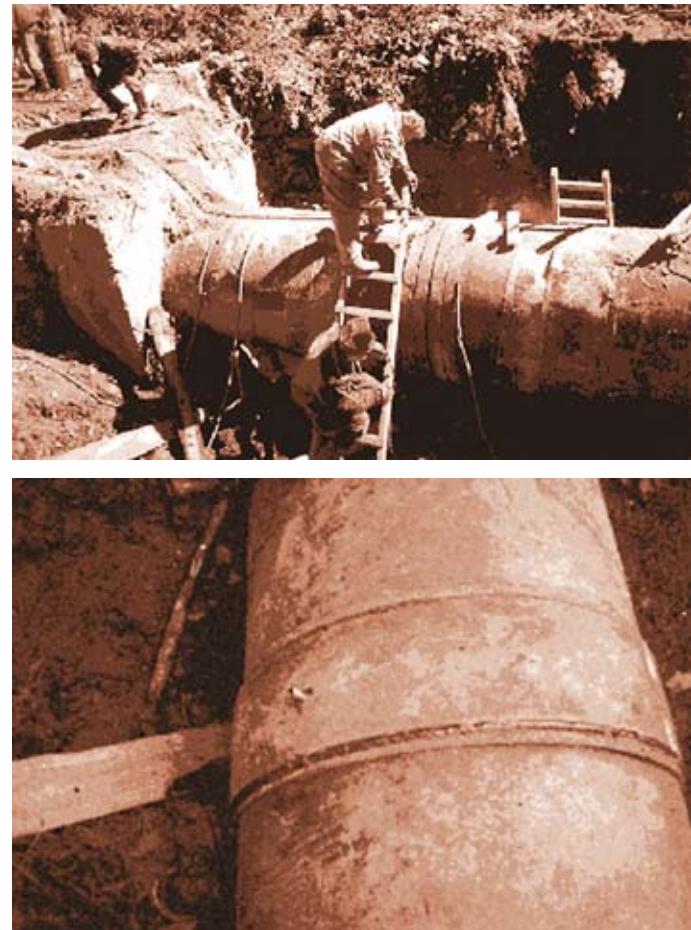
Ремонт дефектного стыка на действующем магистральном газопроводе «Союз» Ду1400: а — сборка нахлесточно-стыковых соединений; б — внешний вид усиливающей двухслойной муфты
